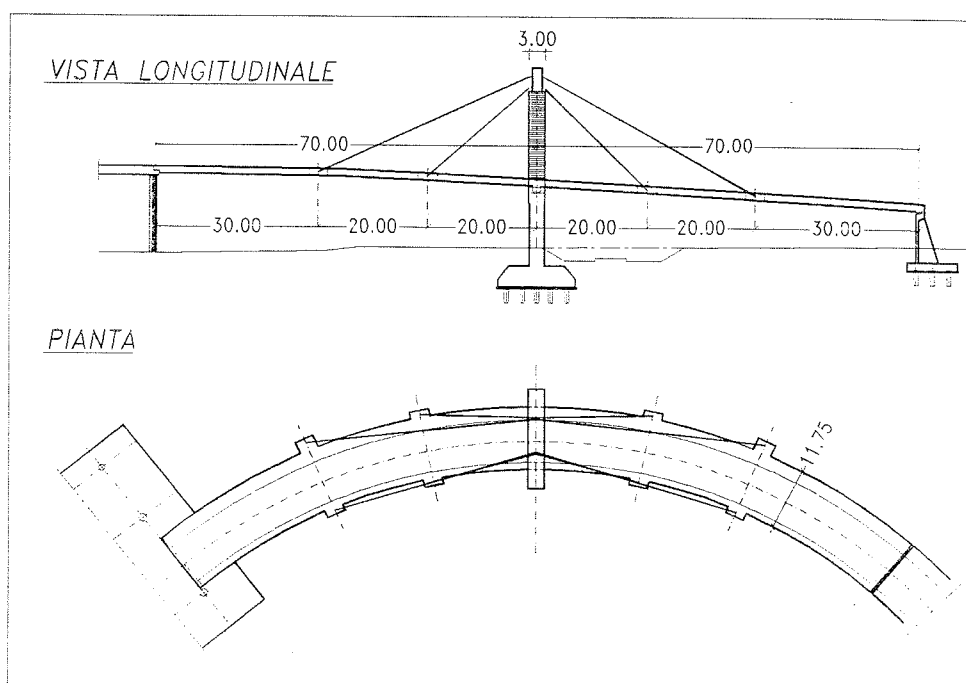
Vista longitudinale e pianta dei viadotti strallati d'accesso all'aerostazione di Malpensa 2000
